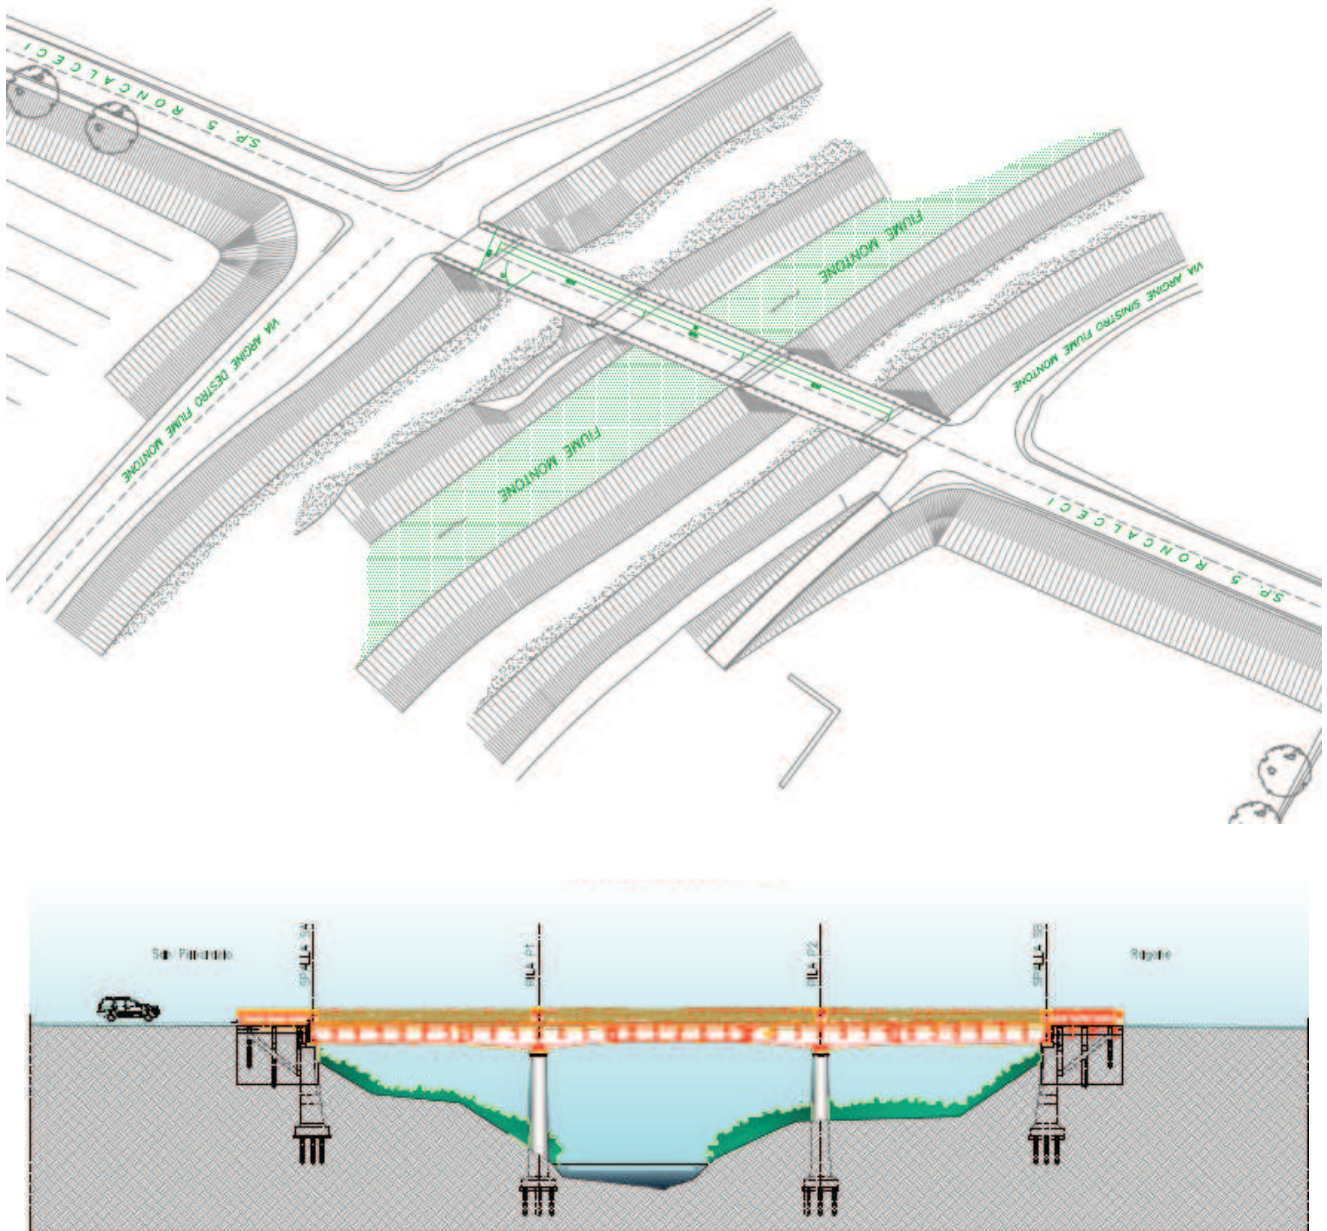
Planimetria e prospetto del ponte di progetto (in rosso l'impalcato di progetto ed in giallo quello esistente da demolire)
